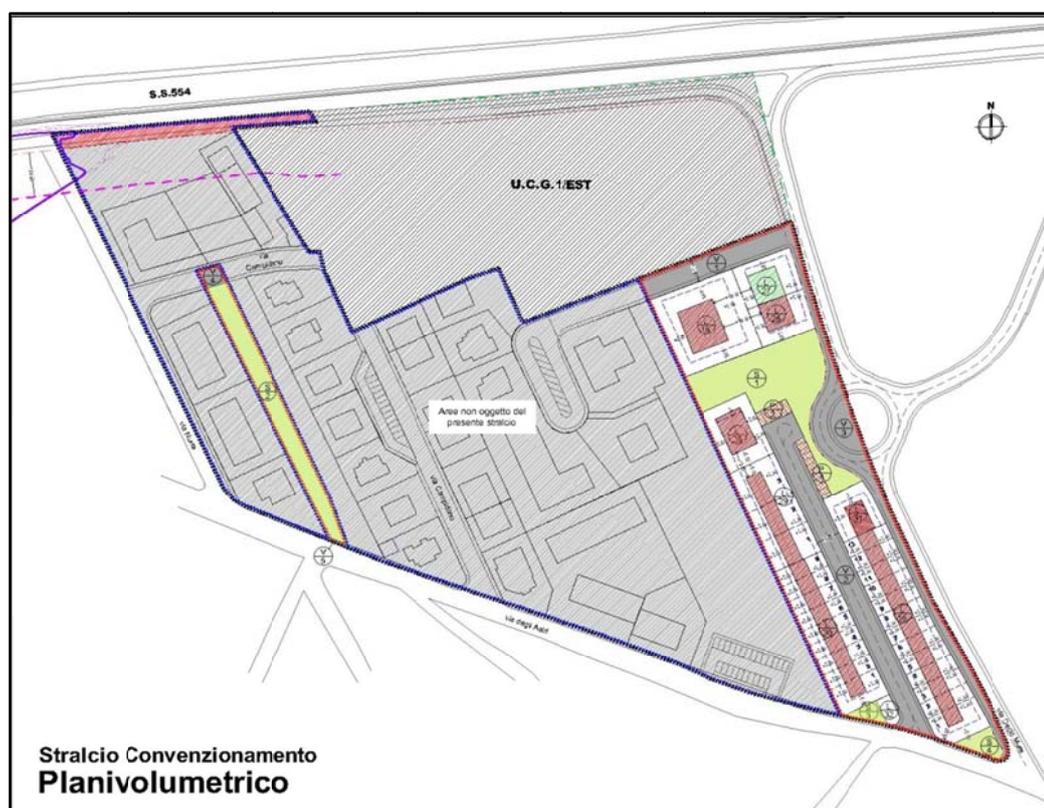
Planivolumetrico: stralcio Convenzionamento
